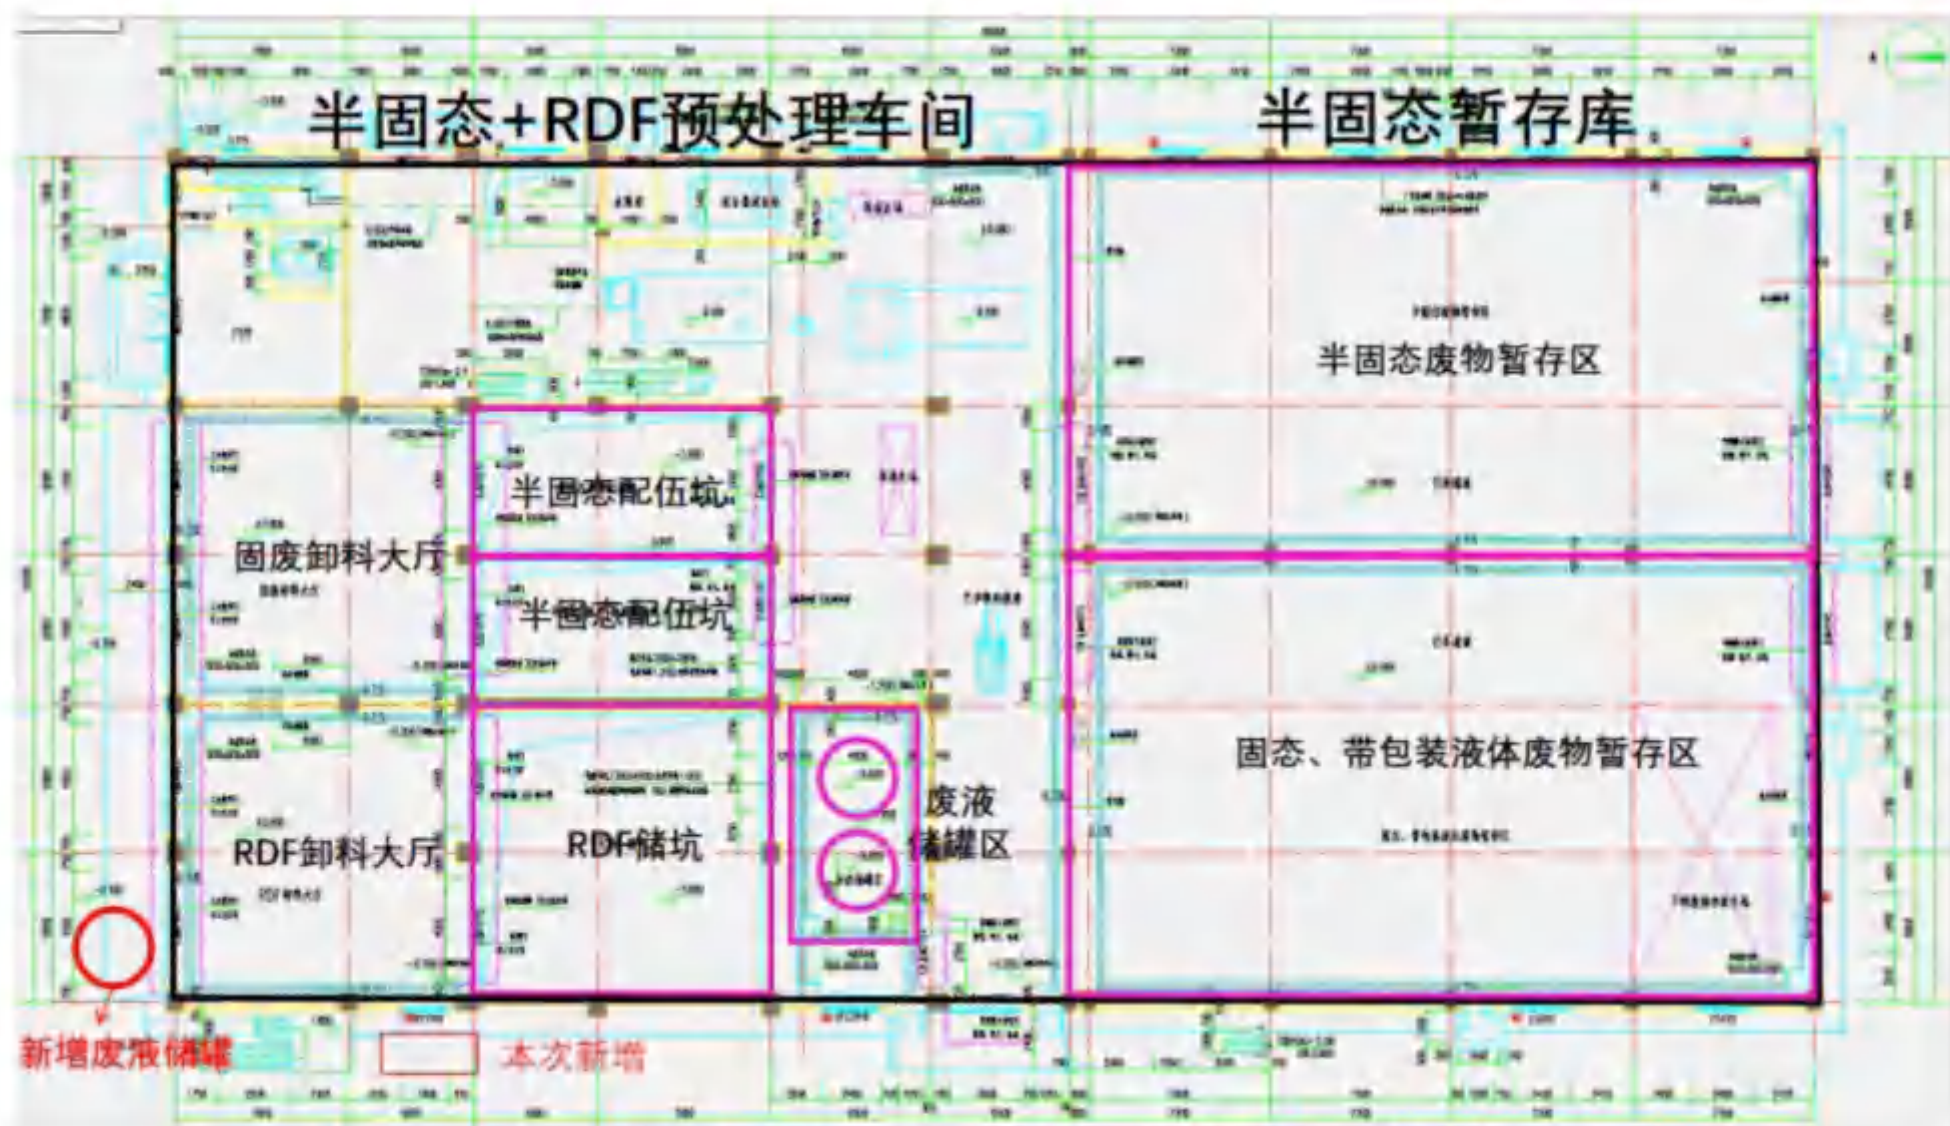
技改项目半固态暂存库、半固态+RDF 预处理车间平面布置图
